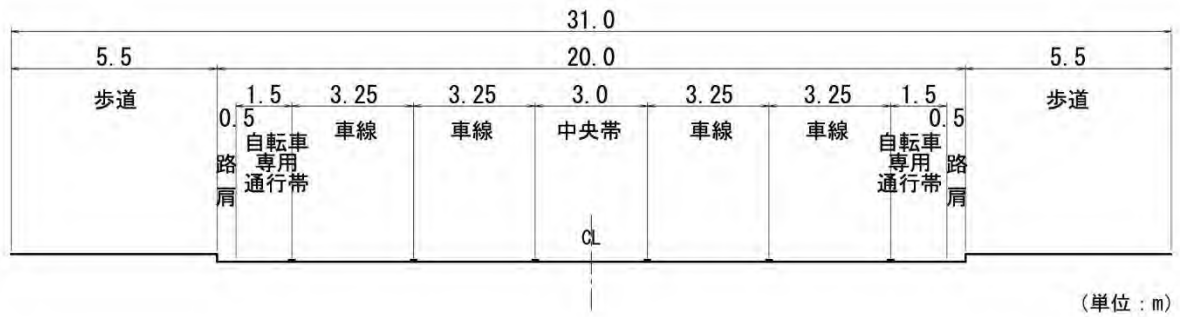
(2) 環状 4 号線 (南区間) の標準断面図
